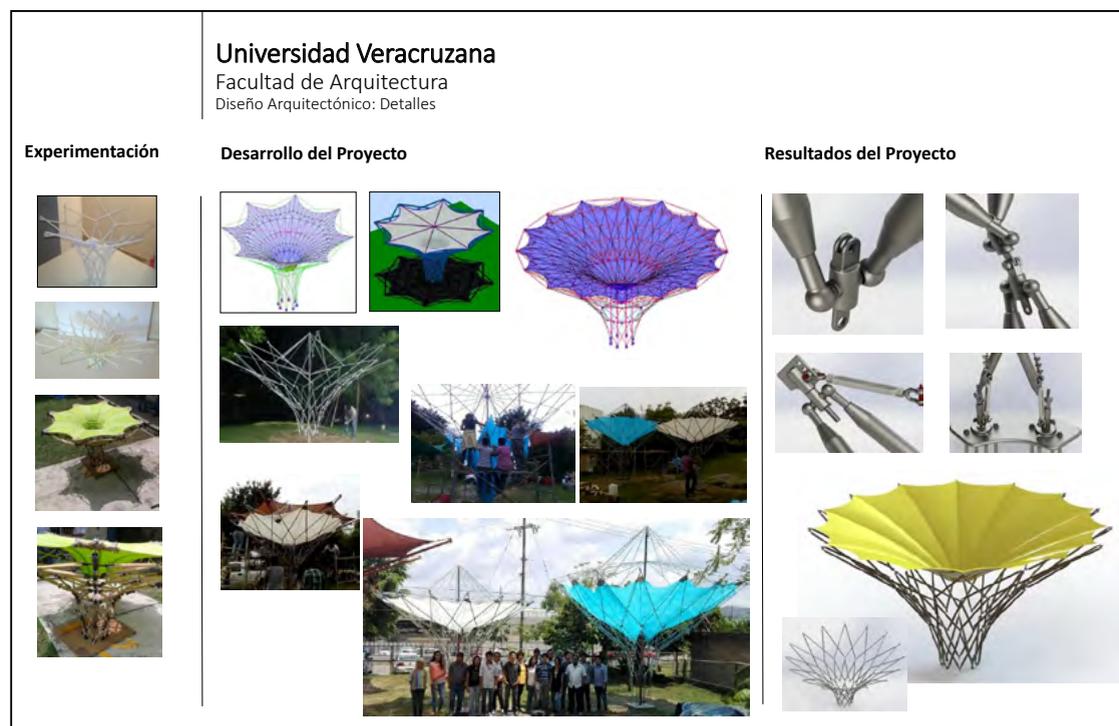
Propuesta de cubiertas ligeras: paraguas plegable tensado.
